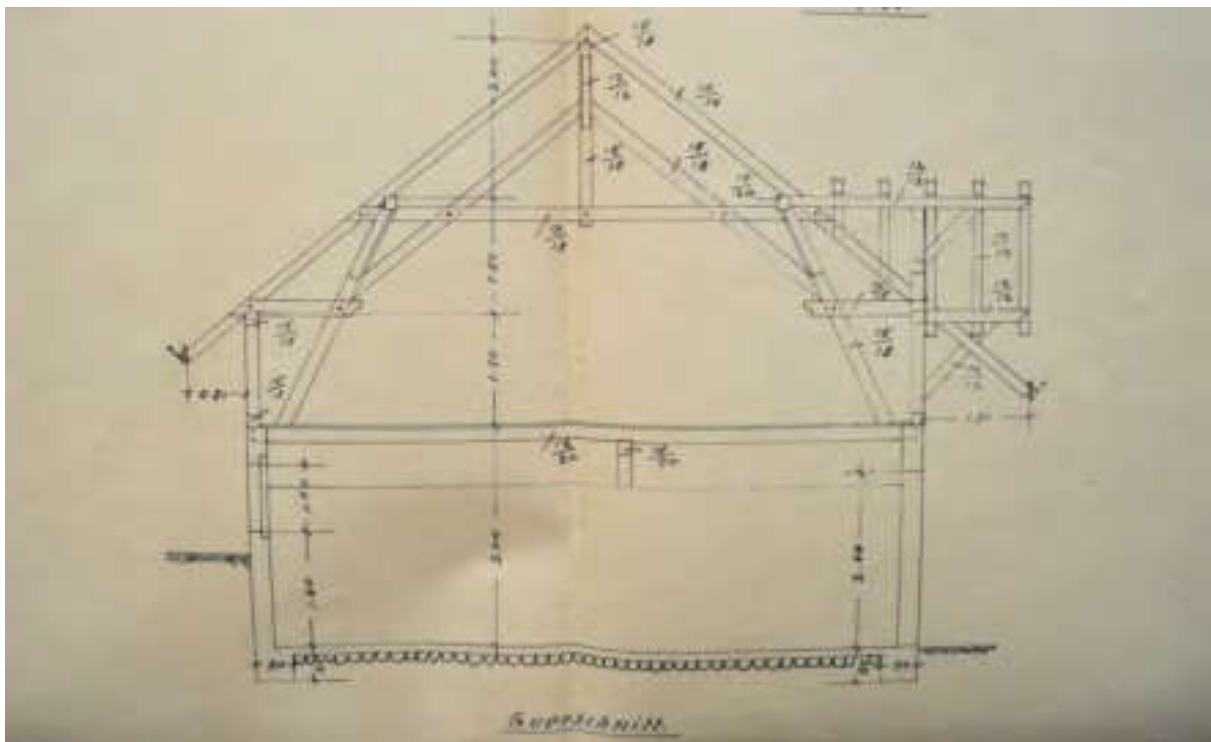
Baueingabeplan Ökonomiegebäude Assek.-Nr. 350, Querschnitt 1:50, 25.09.1939, Markwalder Baubüro. Quelle: GdeA.
